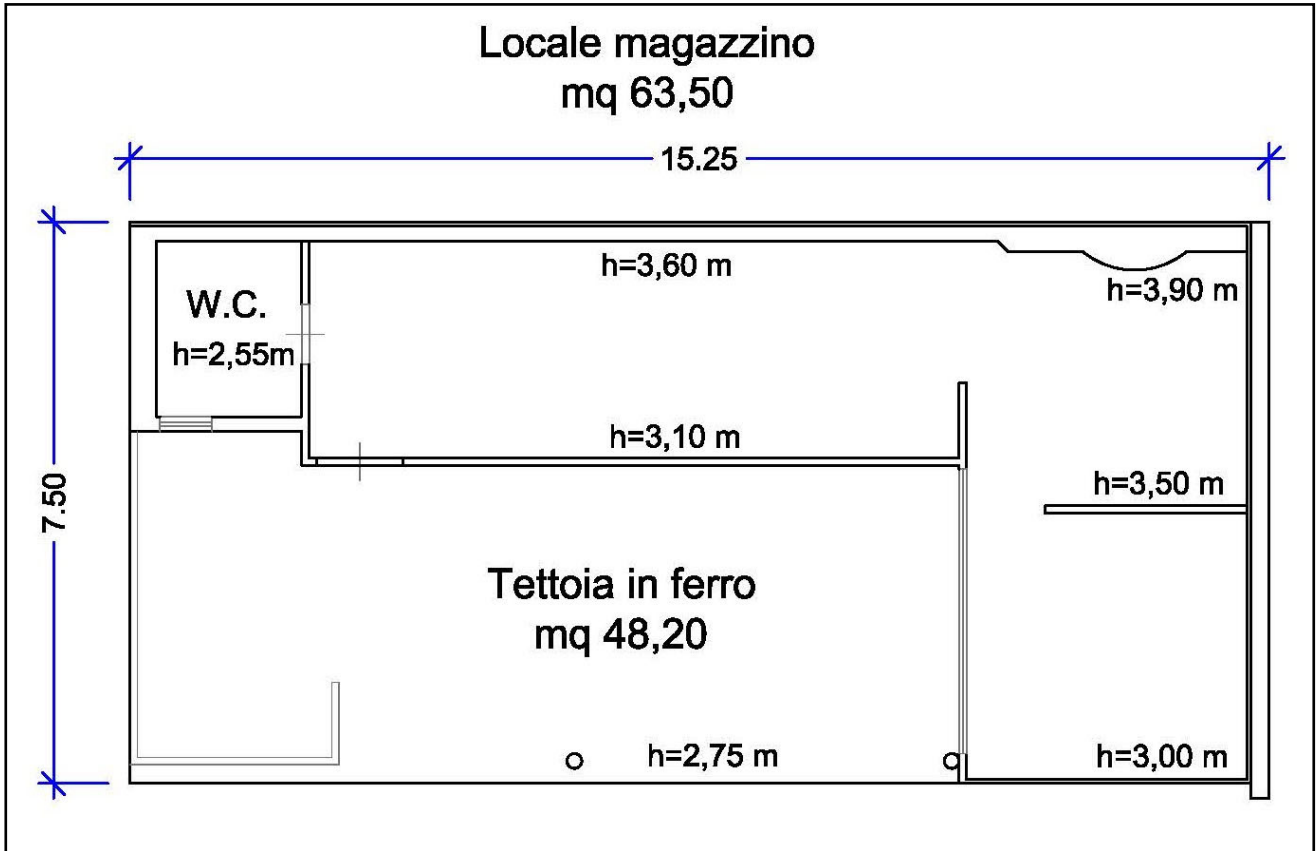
Planimetria generale dei luoghi ove ubicati i manufatti abusivi
